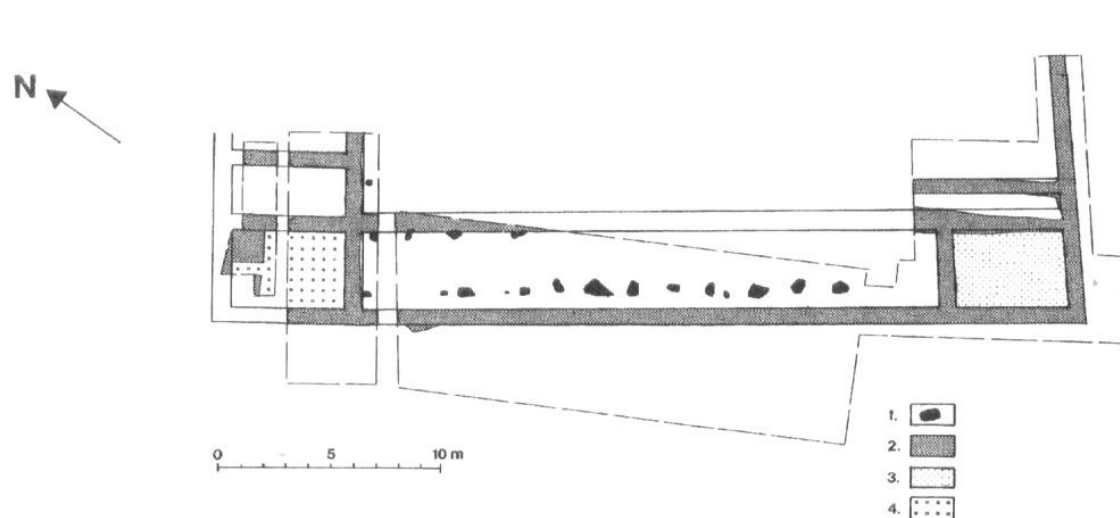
Tiegem (W. Fl.) Vereinfachter Grundriss der Römervilla. 1. Pfostenlöcher des Holzbaus; 2. Fundamentierungsreste des Steinbaus; 3. Kellergeschoss; 4. Hypocaustum (Nach DE COCK, S. 1988. 78.
